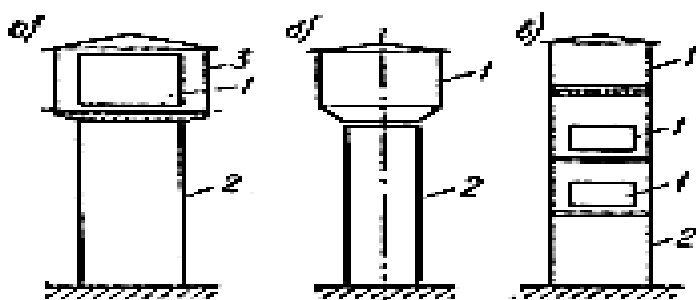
Типи водонапірних башт: а – шатрові; б – безшатрові; в – з декількома резервуарами: 1 – резервуар; 2 – ствол або опорні конструкції; 3 – шатро
